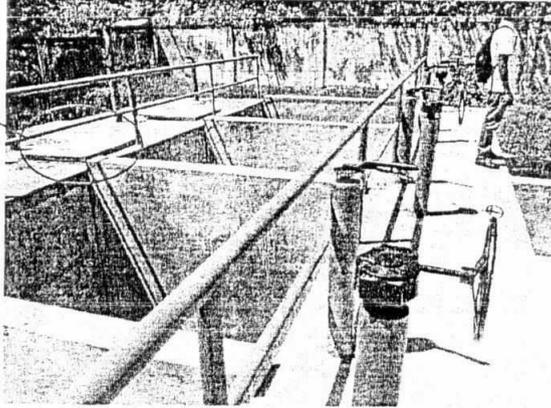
VÁLVULAS MALOGRADAS DE CÁMARA DE AISLAMIENTO
